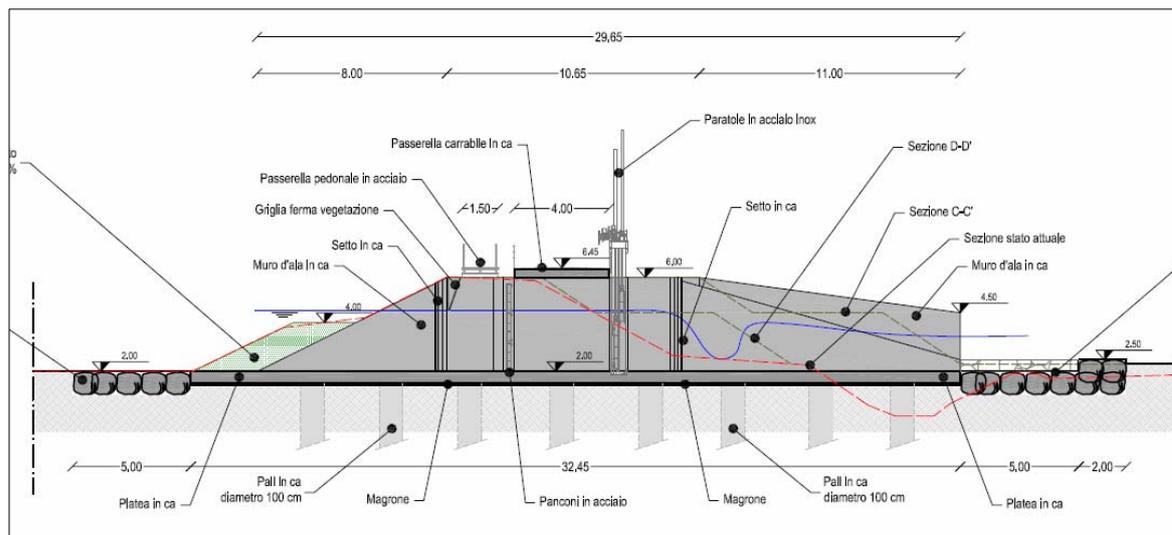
SEZIONE DELL' OPERA DI PRESA
